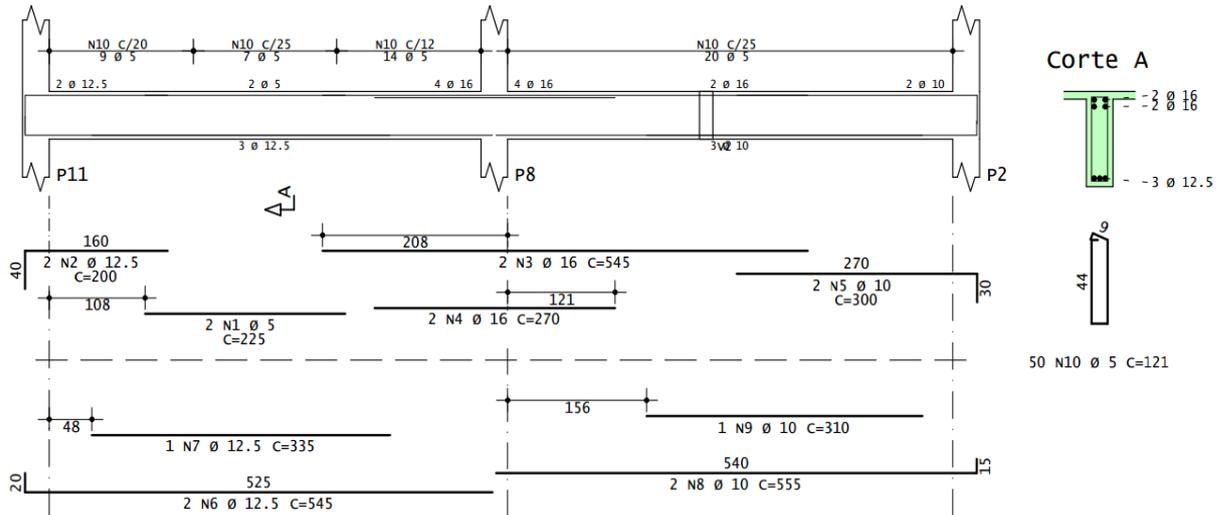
Armadura da viga V8 – pavimento superior (nível +3,00)
